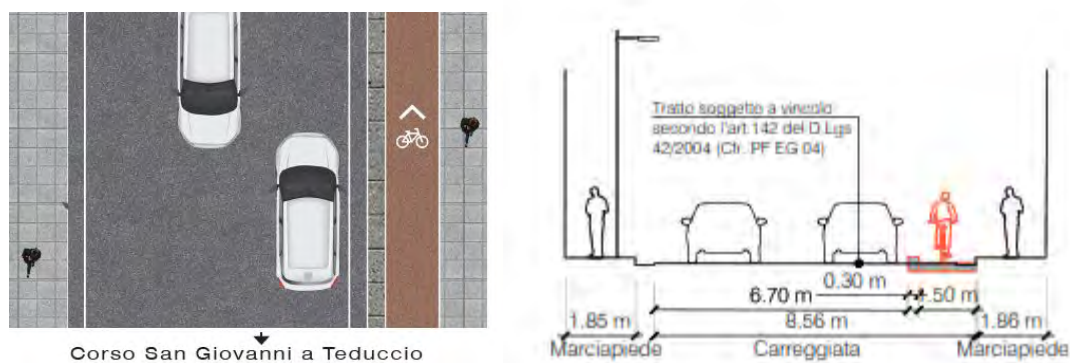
Sezione trasversale e pianta di progetto Corso Protopisani
